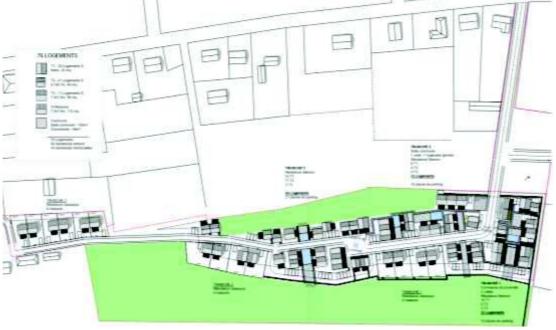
Plans masse du projet Les Terrasses (source : Atelier d'Architecture Anthony Béchu)
